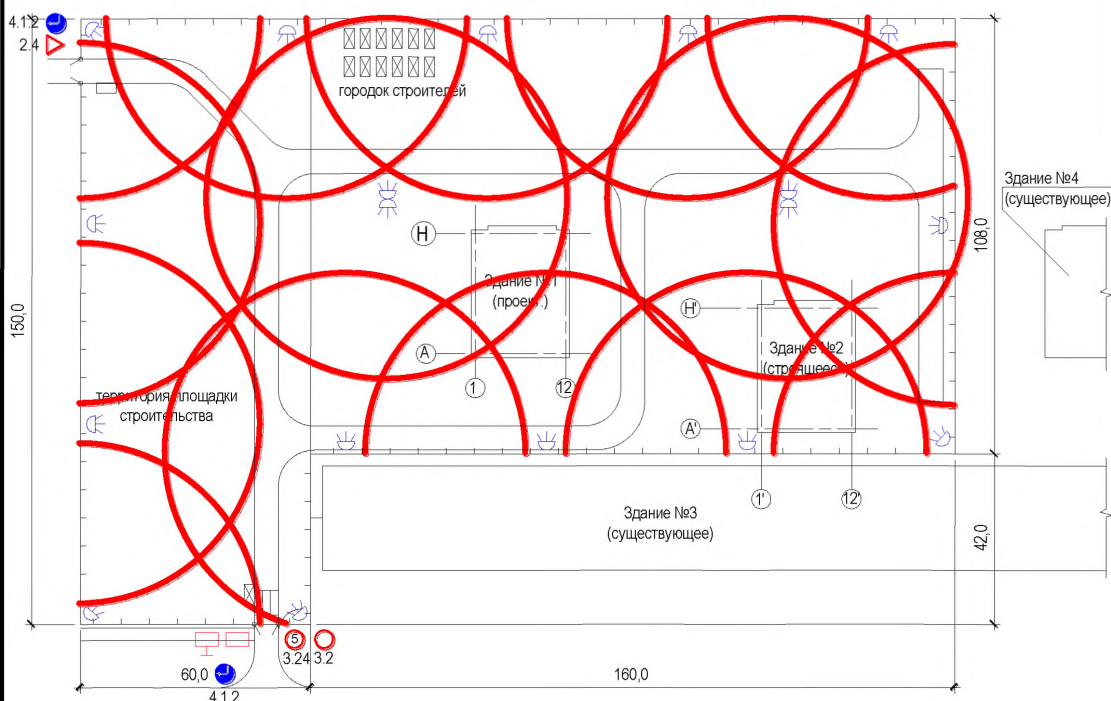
Размещение осветительных мачт на территории строительной площадки.
